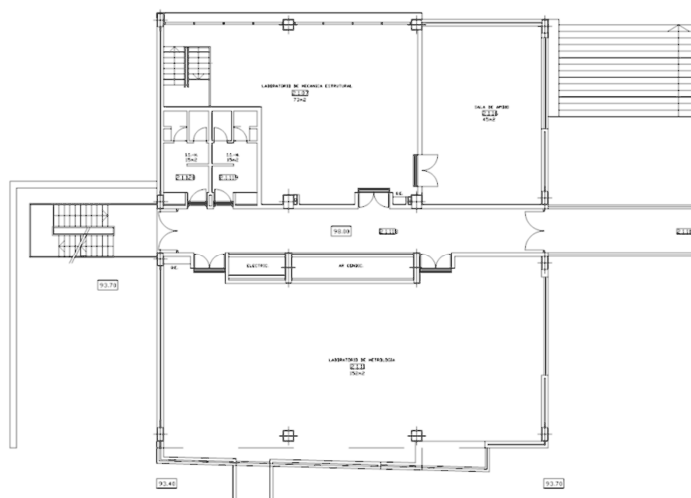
Vista superior detalhada do corpo Sul, piso nº2.
